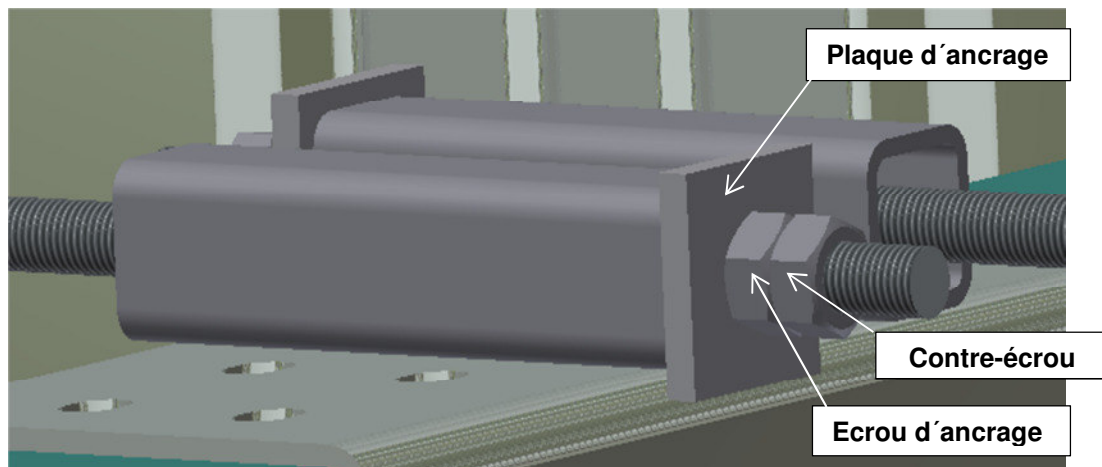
Détail de la vis avec la plaque d'ancrage et un contre-écrou
